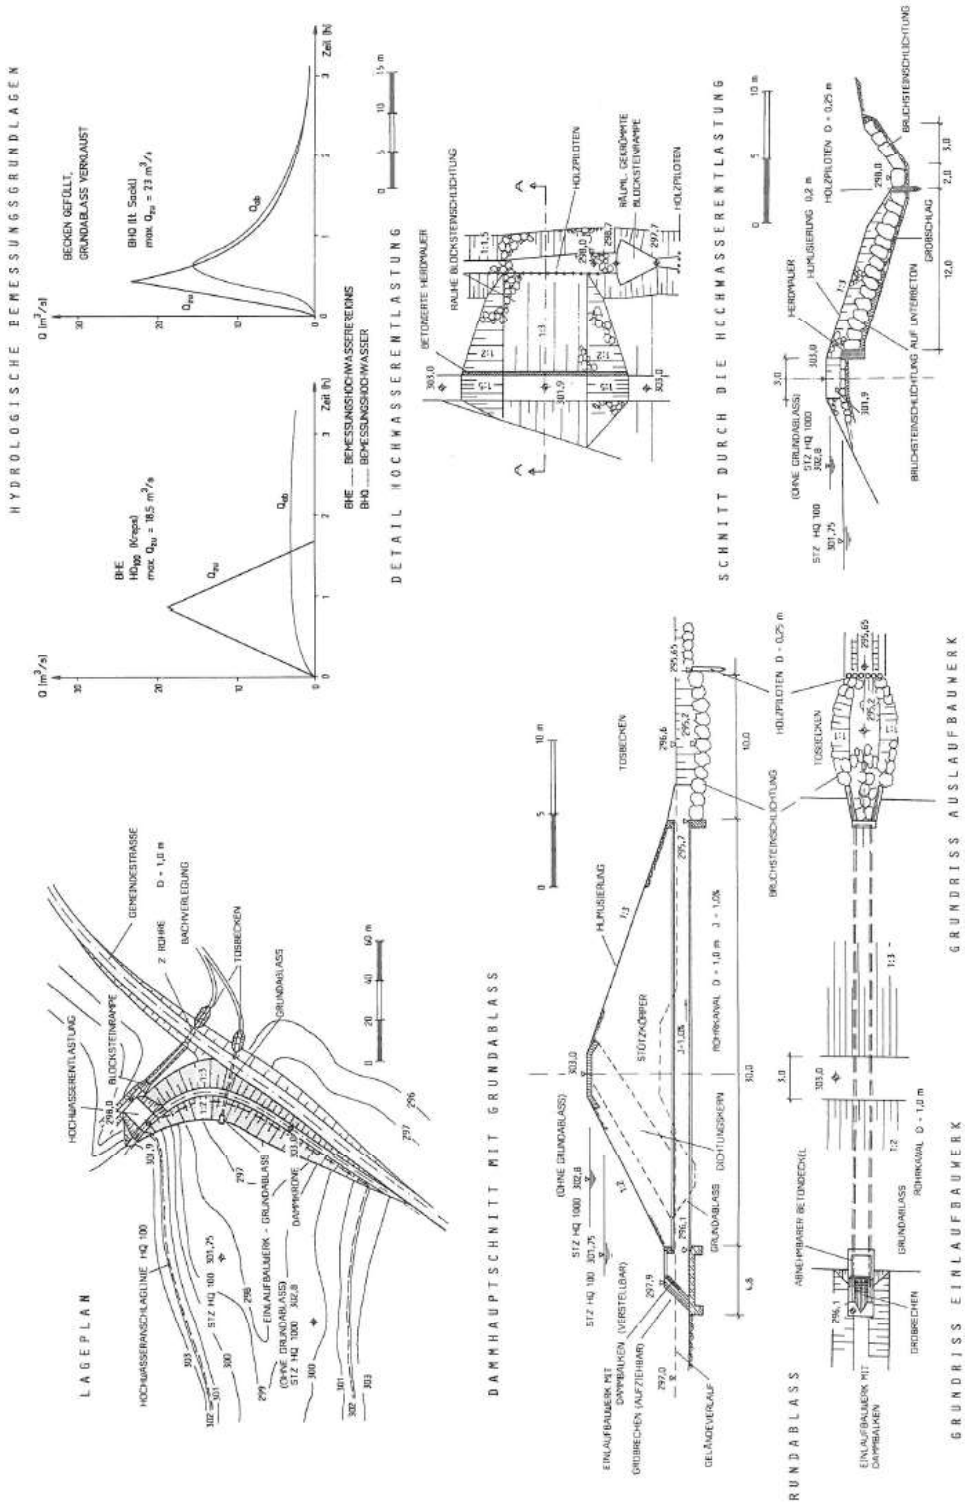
Lageplan und Schnitte, HRB Lichenbach
